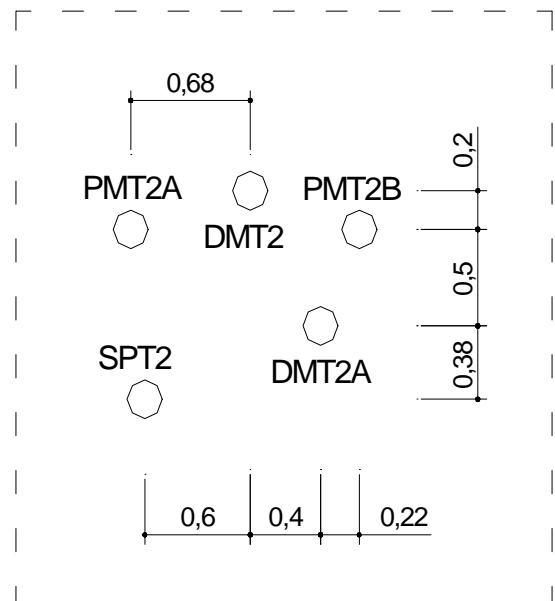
Planta baixa do ensaio de prova de carga com PMT, SPT e DMT
